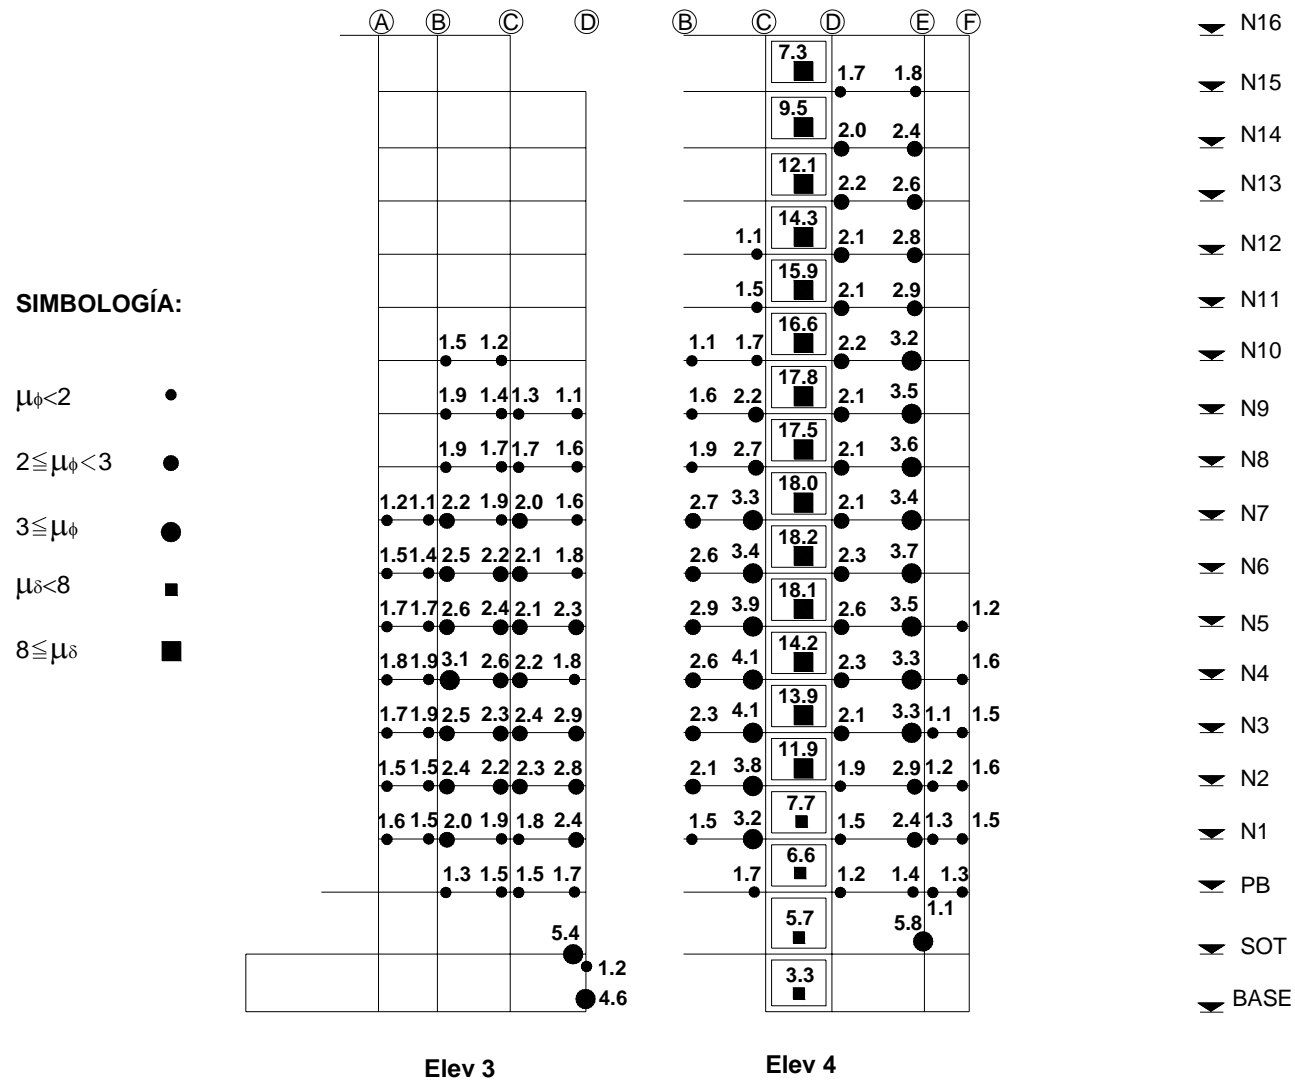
Ductilidades locales máximas de vigas, columnas y muros de concreto reforzado, en las elevaciones 3 y 4, para la SIM81
